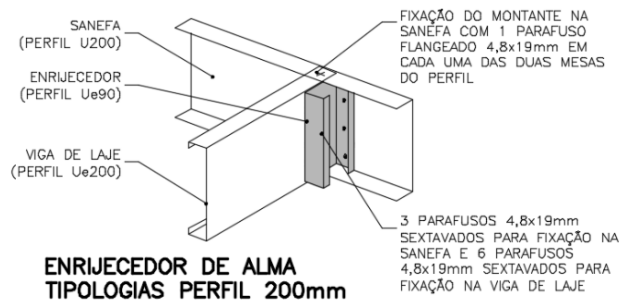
Detalhes de instalação de enrijecedores de alma no encontro de vigas de piso com sanefa
